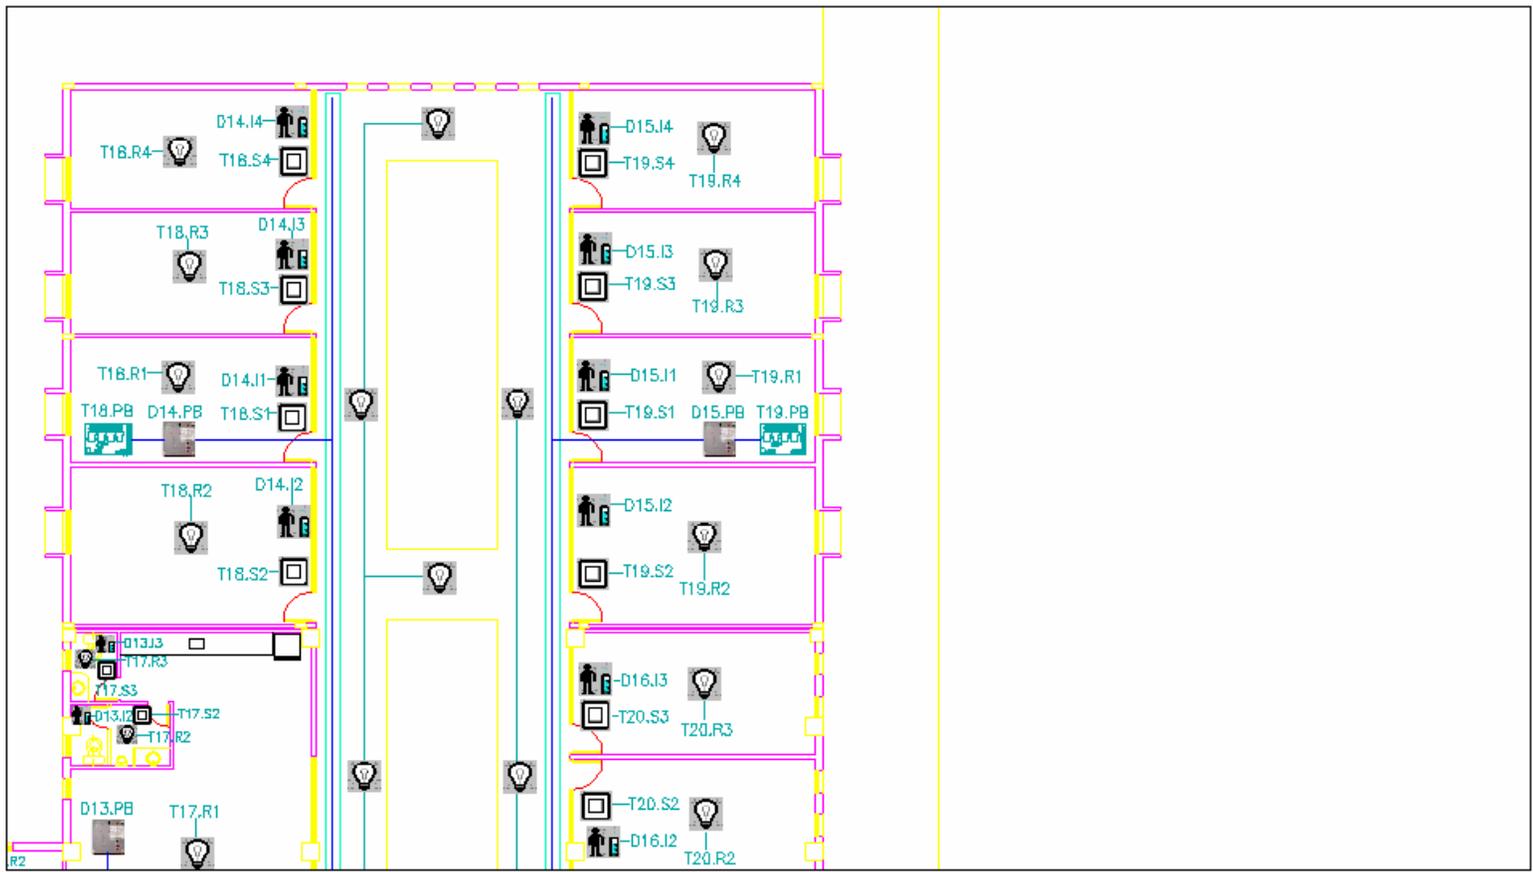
PLANO ILUMINACION PLANTA BAJA SECCION 8
